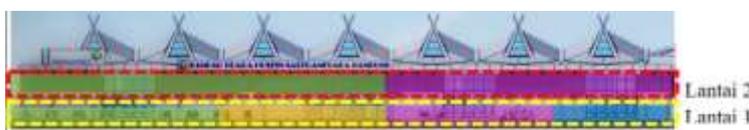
Sirkulasi Penumpang pada Denah Lantai 2 (Sumber: Humas PT. Angkasa Pura II. Edit)
